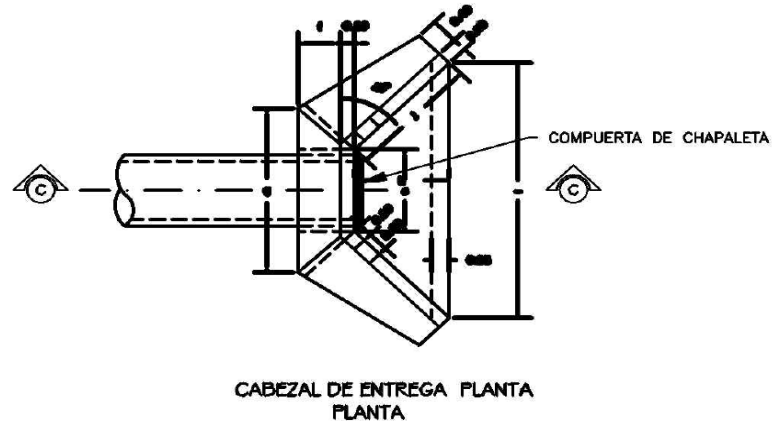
Detalle de las obras del cabezal de descarga, vista en planta.
